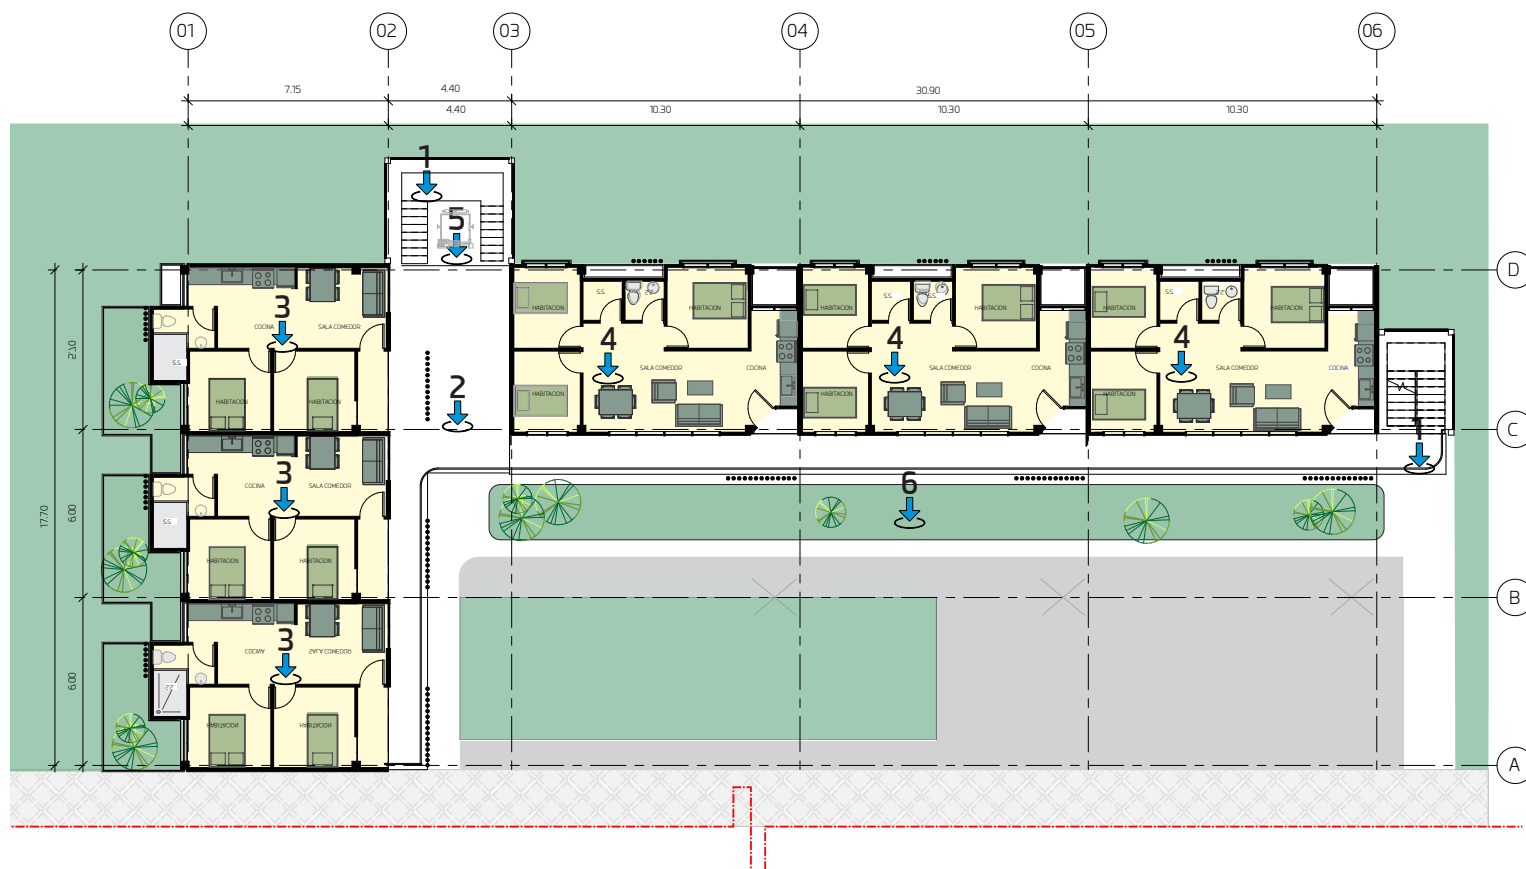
Planta de distribución general de segundo nivel por módulo
